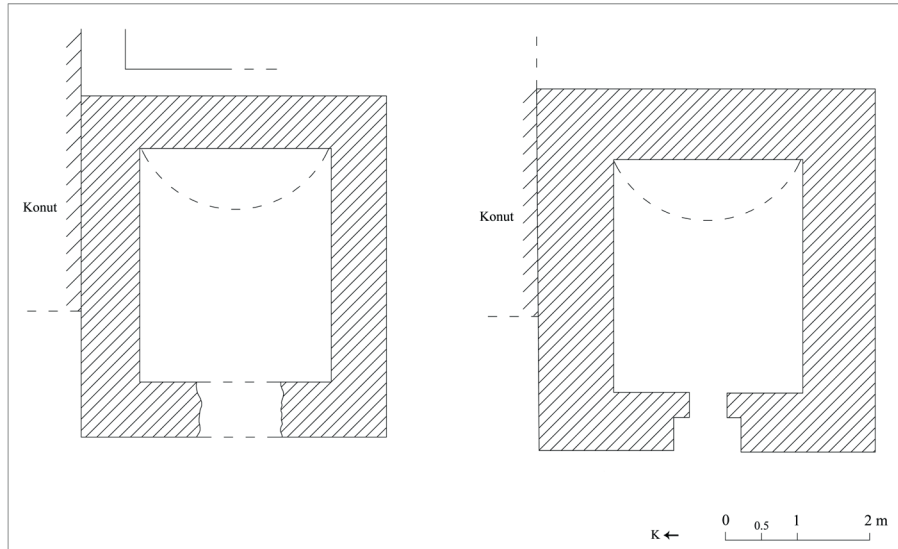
6 nolu mezar, alt ve üst kat planları
